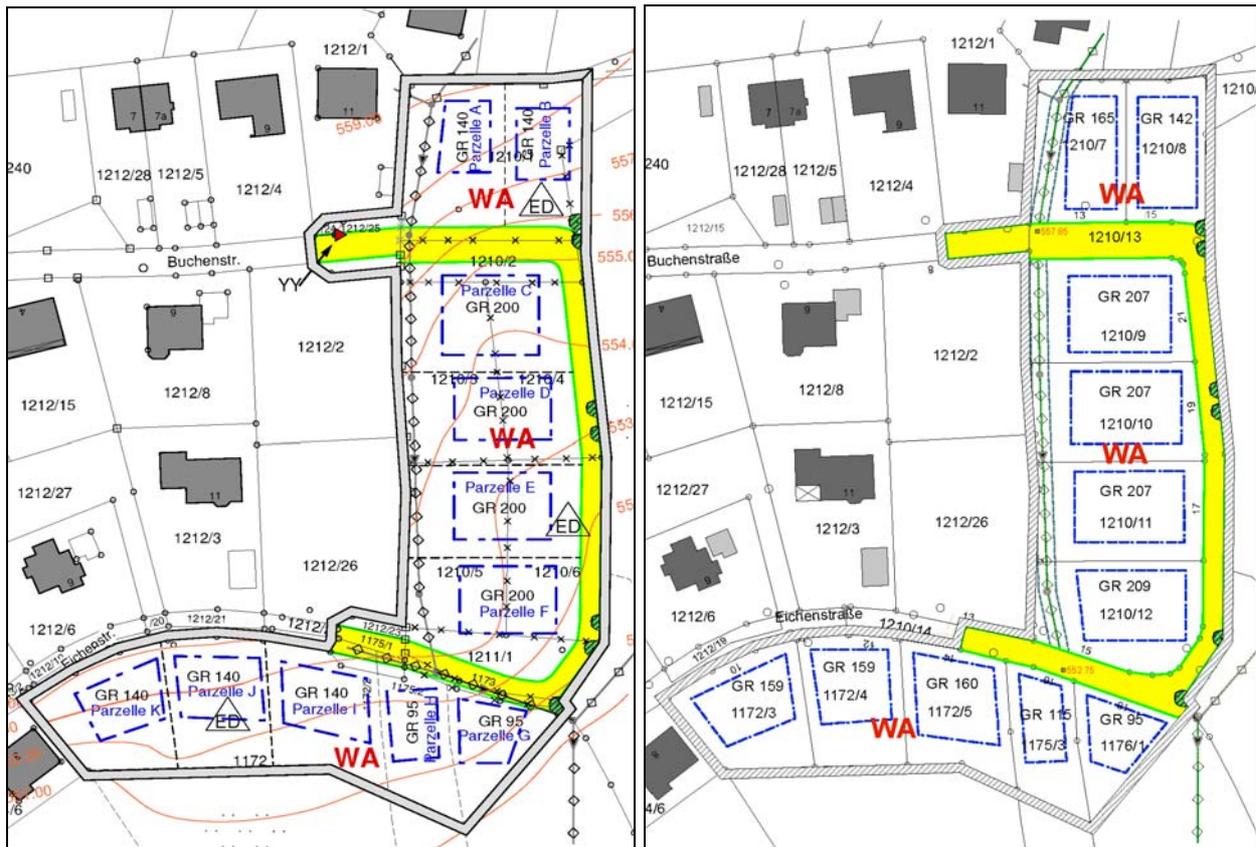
Gegenüberstellung der zulässigen überbaubaren Grundflächen nach dem Baurecht von 2007 (links) und nach der 1. Änderung des Bebauungsplans (rechts)
